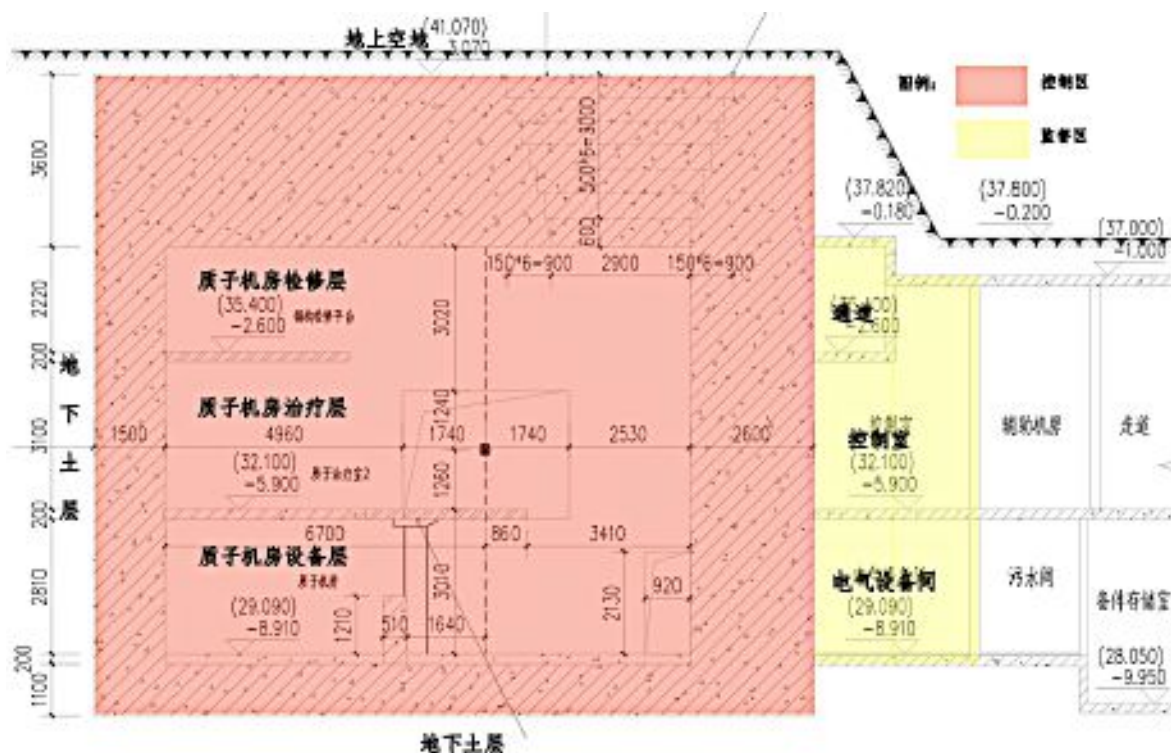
质子治疗机房辐射工作场所分区剖面图（4-4 剖面）
